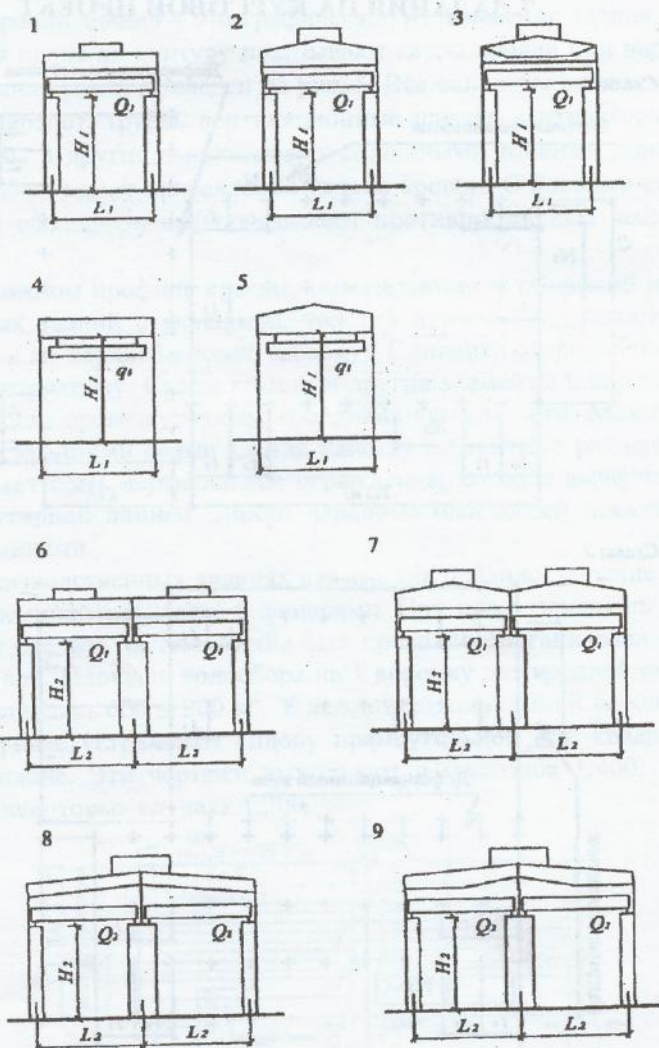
Схемы поперечных резервов зданий (1 – 9)
